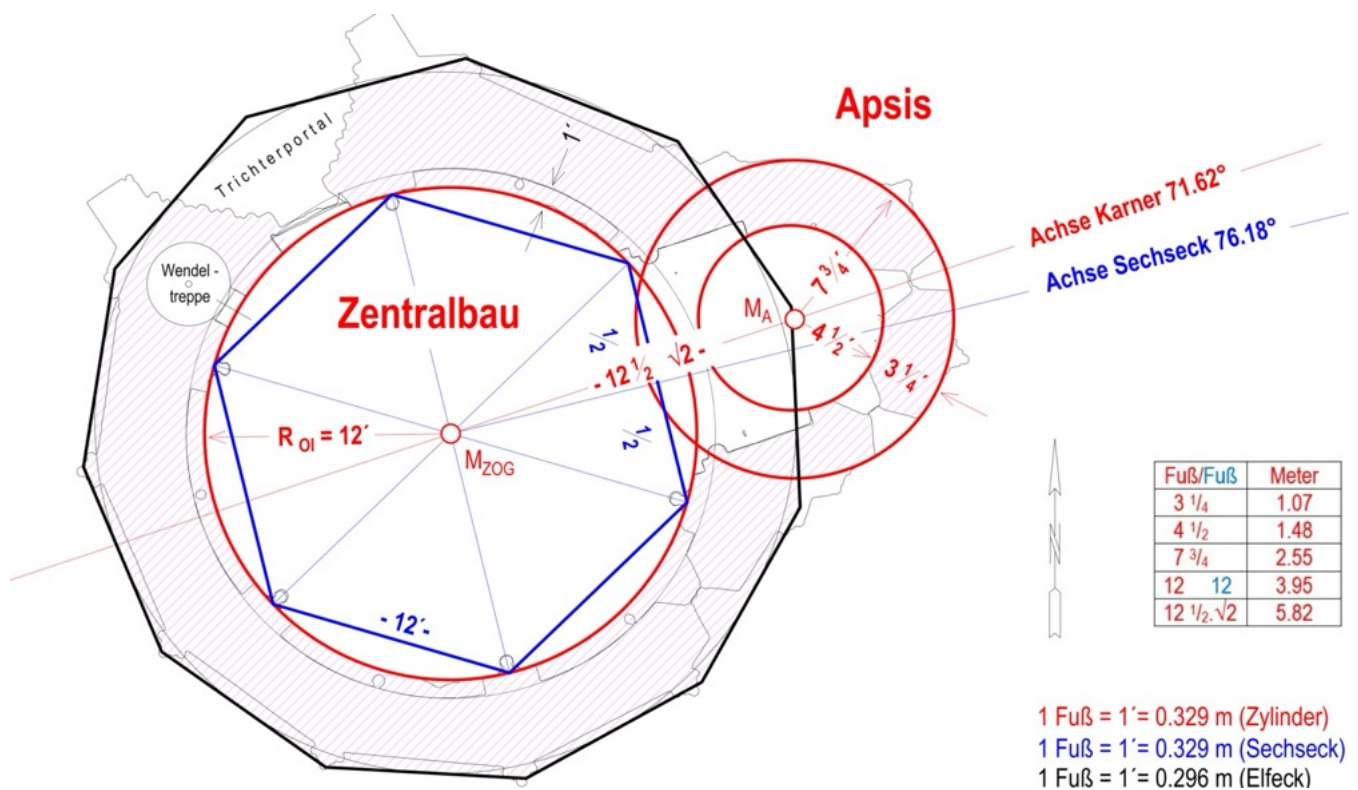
Tullner Karner, Rekonstruktion Obergeschoß (Kapelle mit Zentralbau und Apsis)
